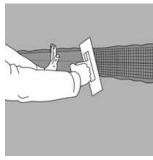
Шпаклевание стыков и мест установки шурупов.
